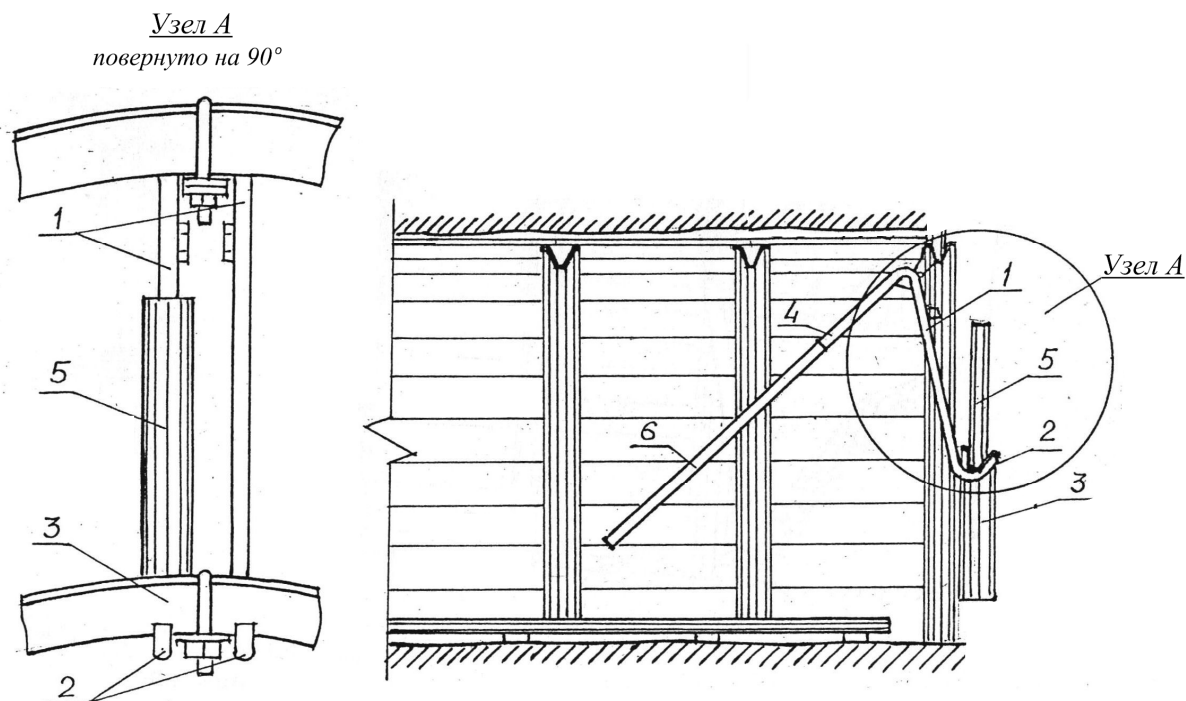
Конструкция крепеустановщика облегченной конструкции:
